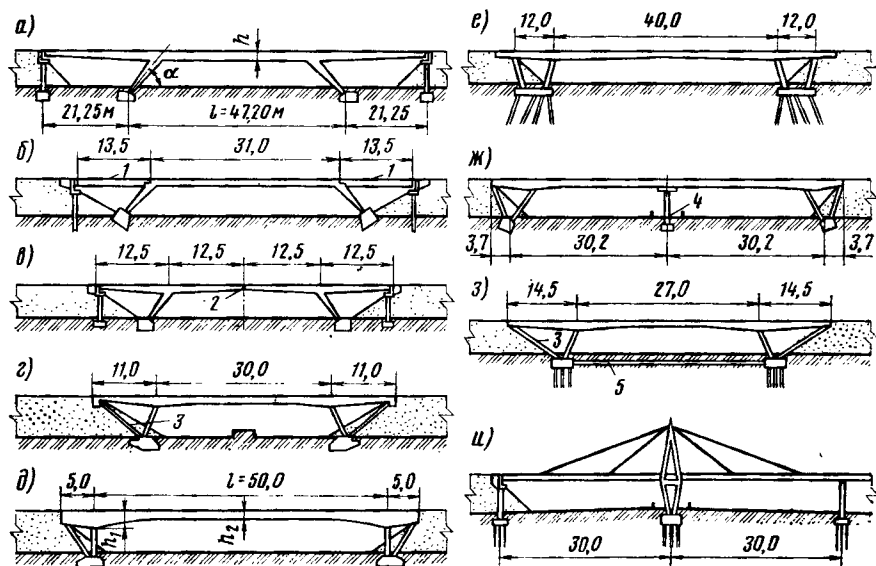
Схемы железобетонных путепроводов рамной и комбинированной систем:
